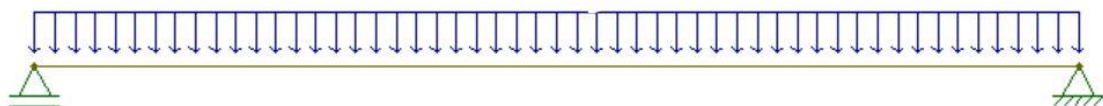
Cálculo da flecha de viga simplesmente apoiada (Carga distribuída)
